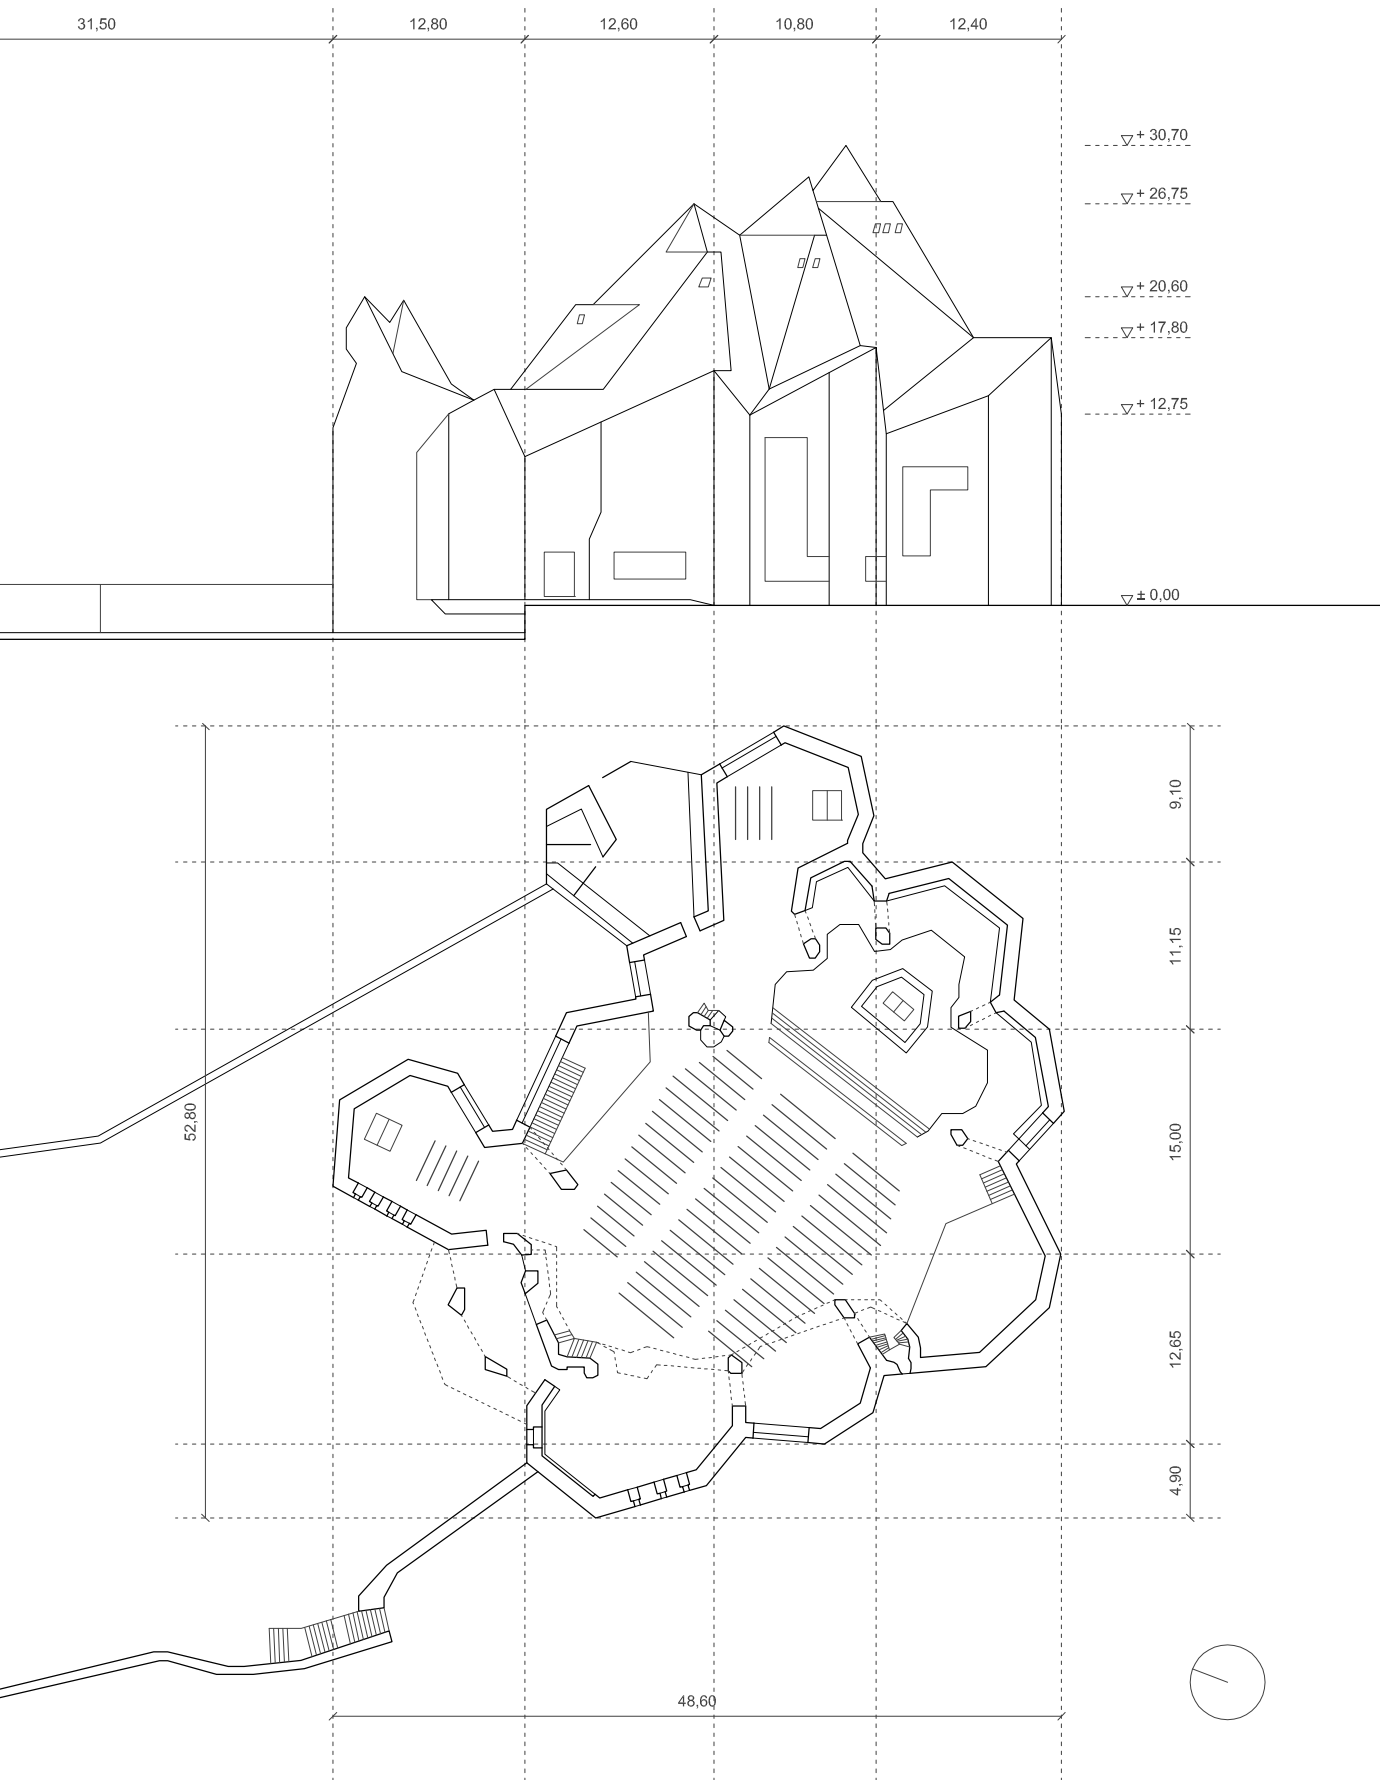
Centro parroquial divide el espacio, contención con muro de hormigón armado.
